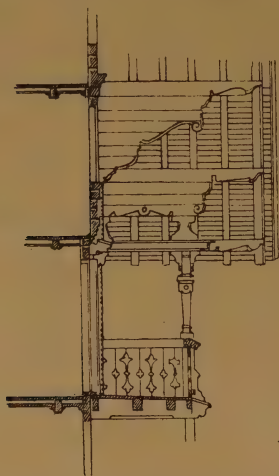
Toiture et balcon d'un chalet à Champen.
